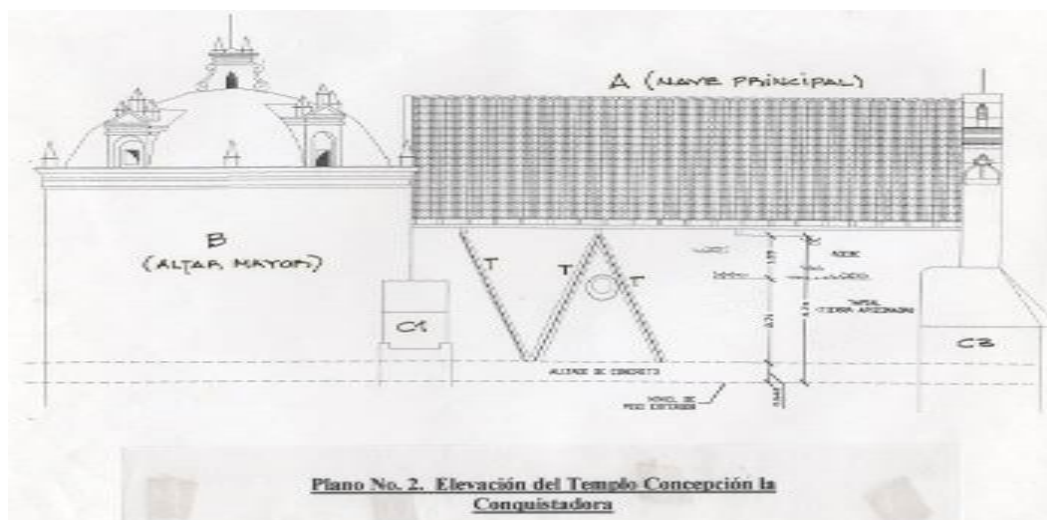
Plano de elevación de la fachada lateral norte del Templo Concepción La Conquistadora, (Quiñónez, 2002)
